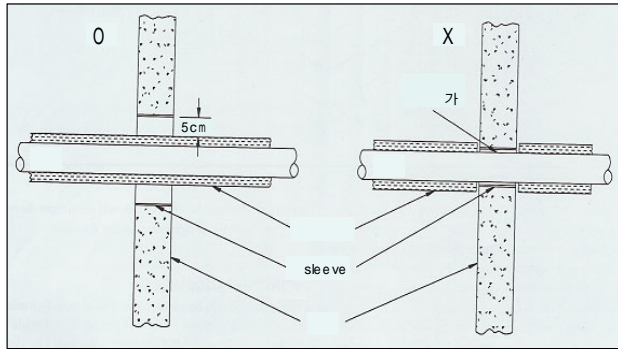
벽 슬라브를 통과한 보온파이프의 시공 단면도
